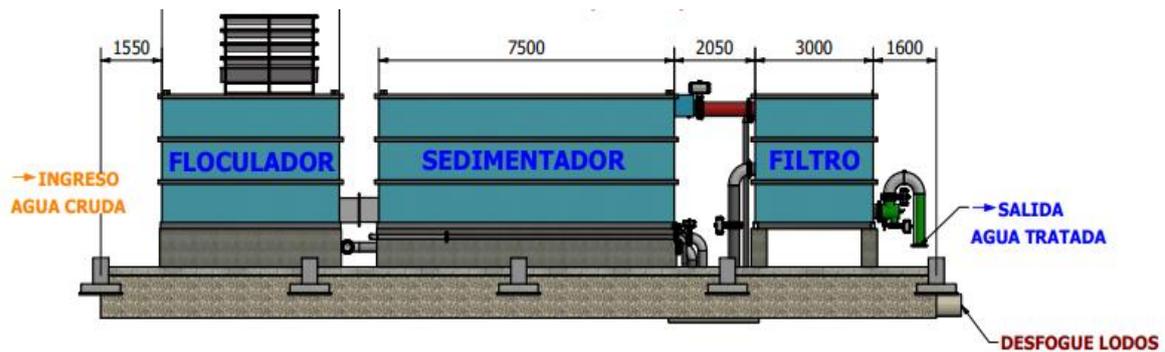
Vista en corte, planta de tratamiento modular 3D
